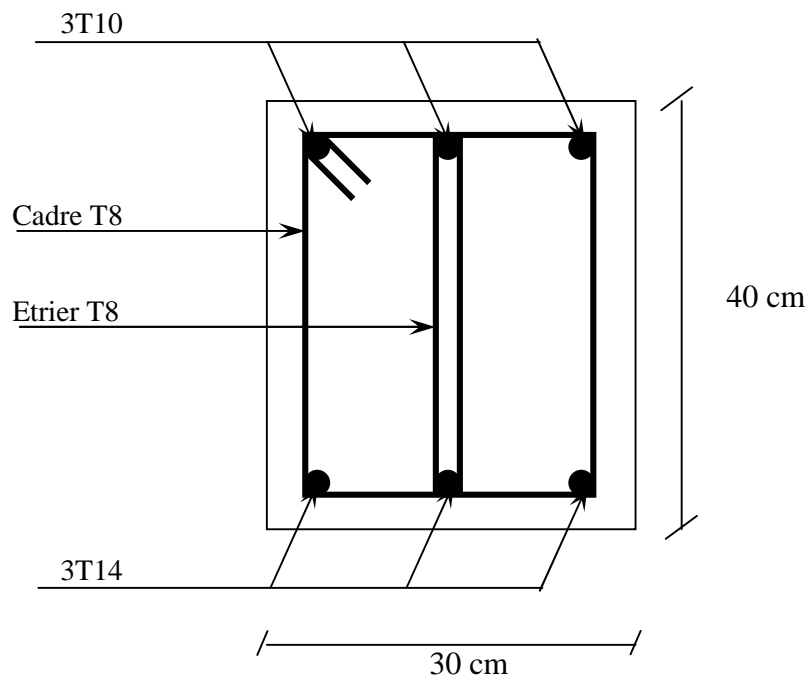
Sch  ma de ferrailage de la poutre de ch  nage
